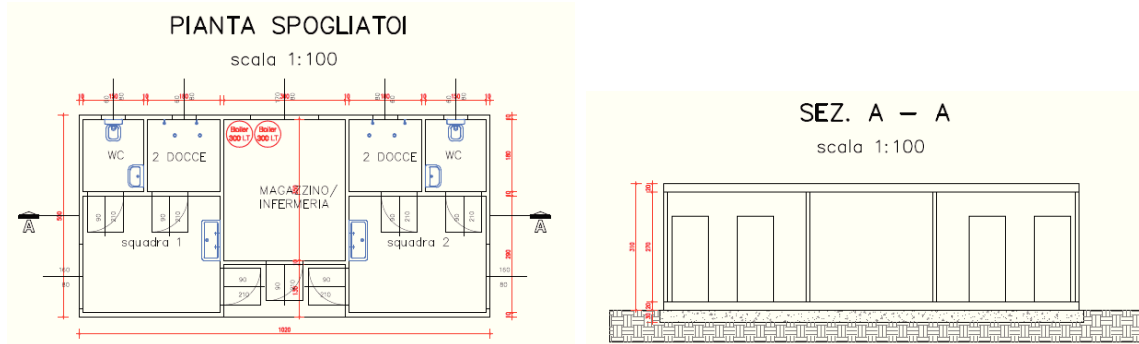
Pianta e sezione dell'edificio da destinare a spogliatoi.
